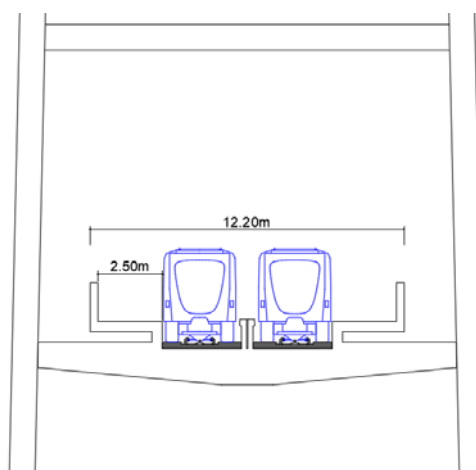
Ponte - Zona atirantada (Seção Transversal)
